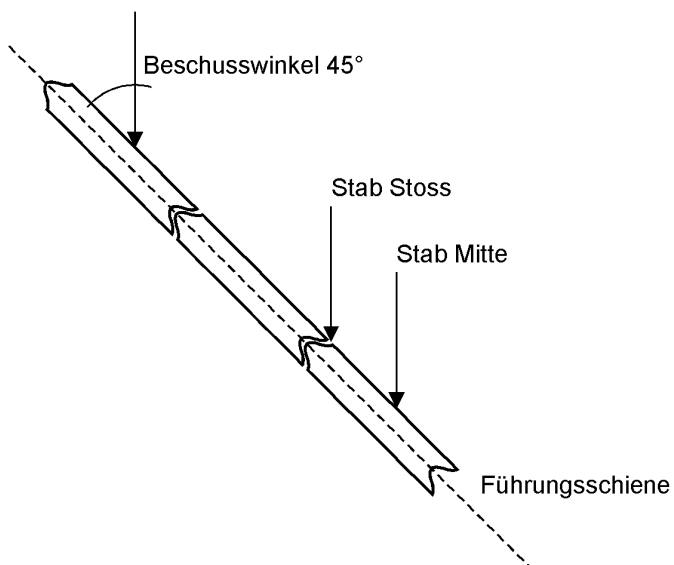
Beschussorte und Beschusswinkel beim Rollladen als Fassadenbauteil im Seitenriss
